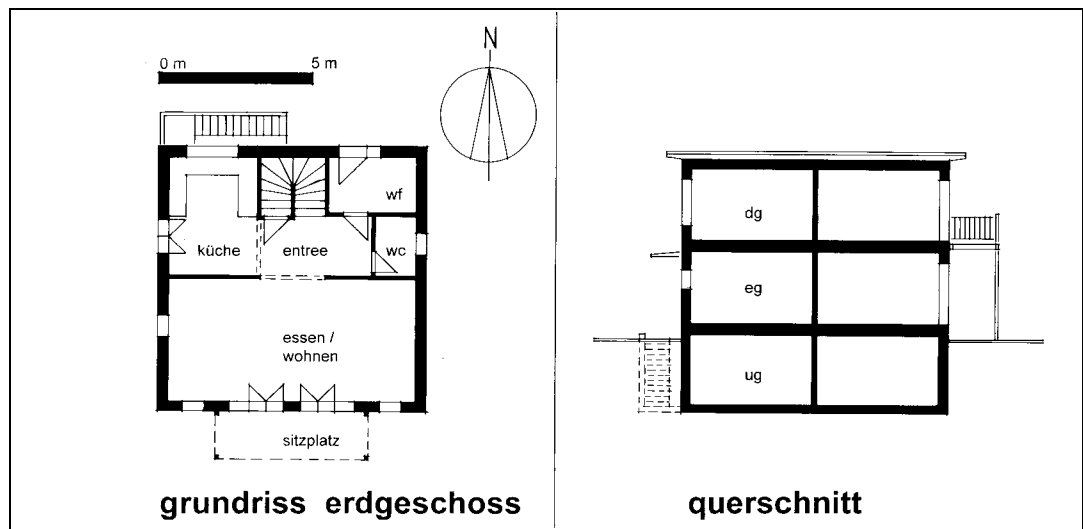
Grundriss Erdgeschoß und Querschnitt von Objekt N_efh.
